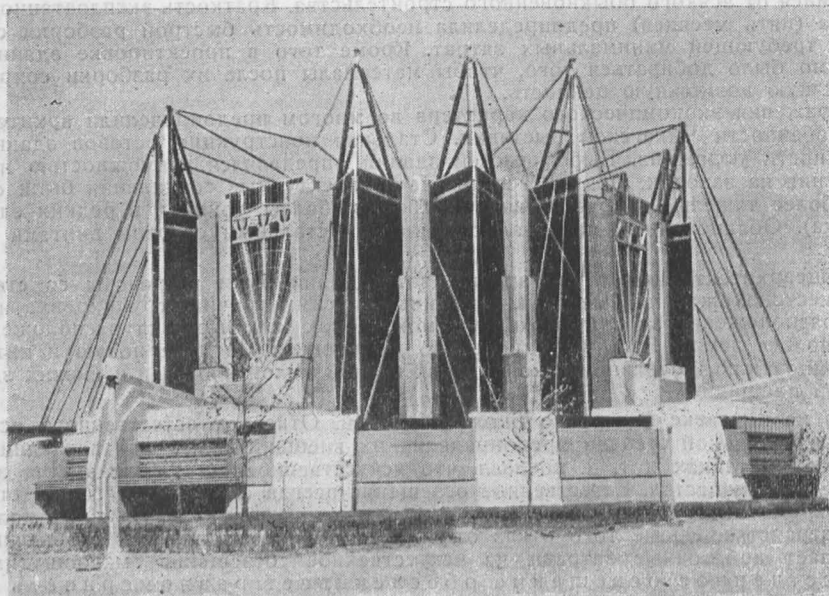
Круглое здание павильона транспорта с подвесным сводом.
